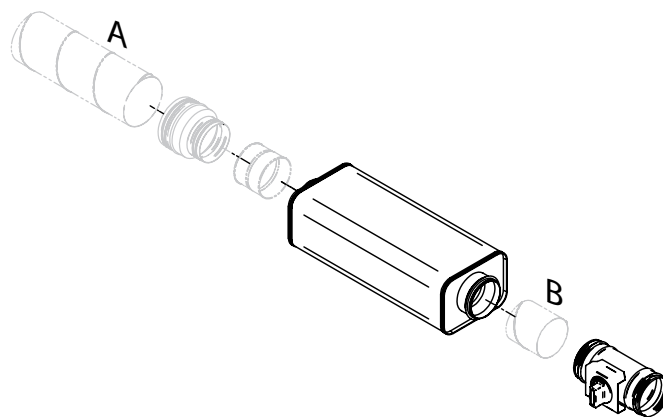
Kit d'air introduit, PARAGON T-SAK-CAV-100
